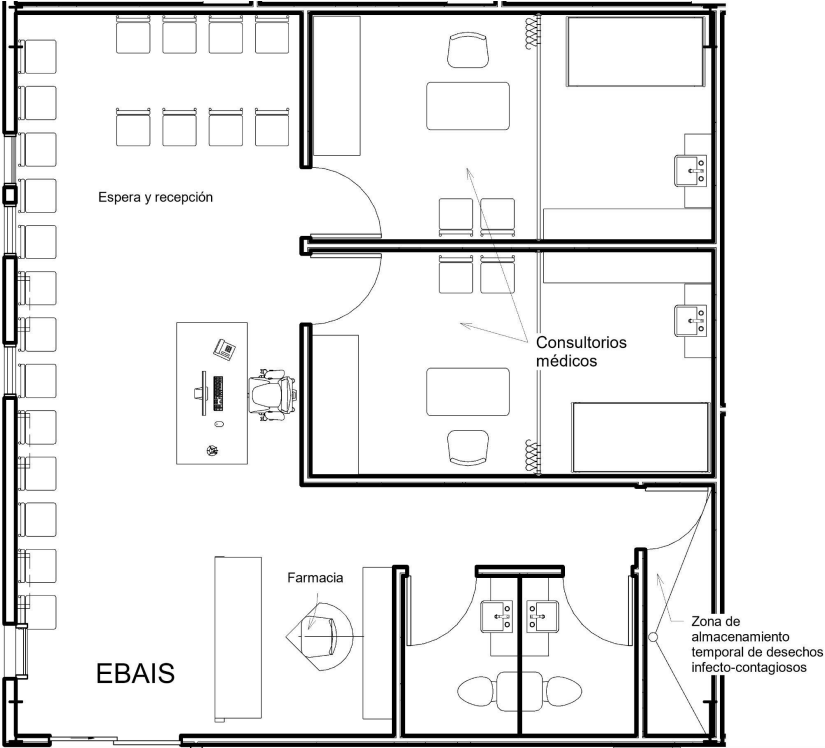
Detalle planta de EBAIS. Fuente propia.
